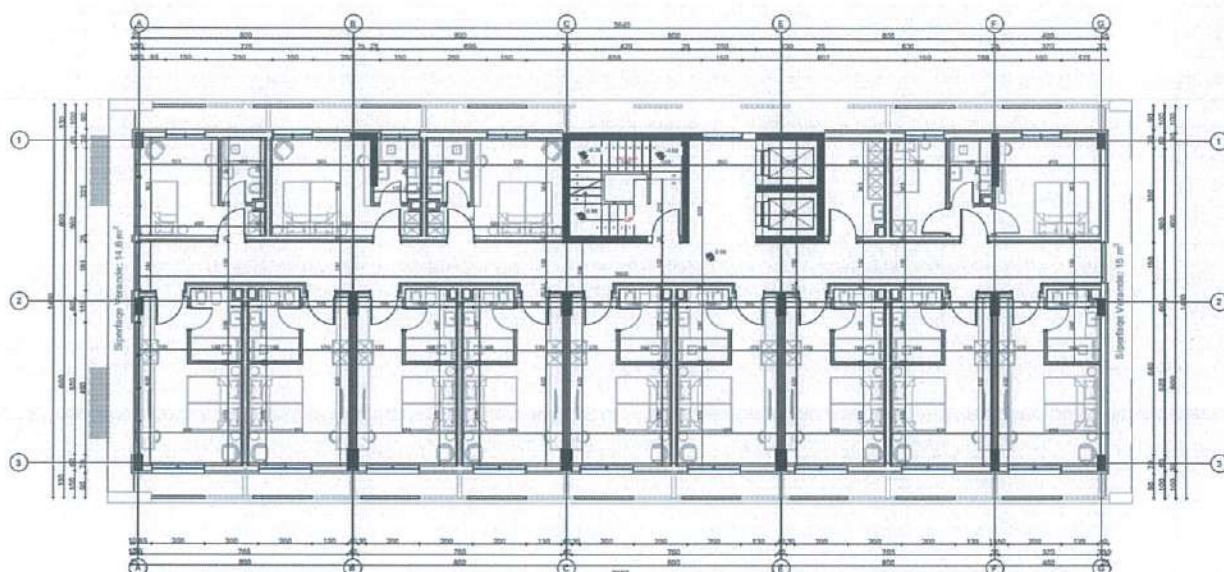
Palacina tip, planimetri, pamje dhe prerje
